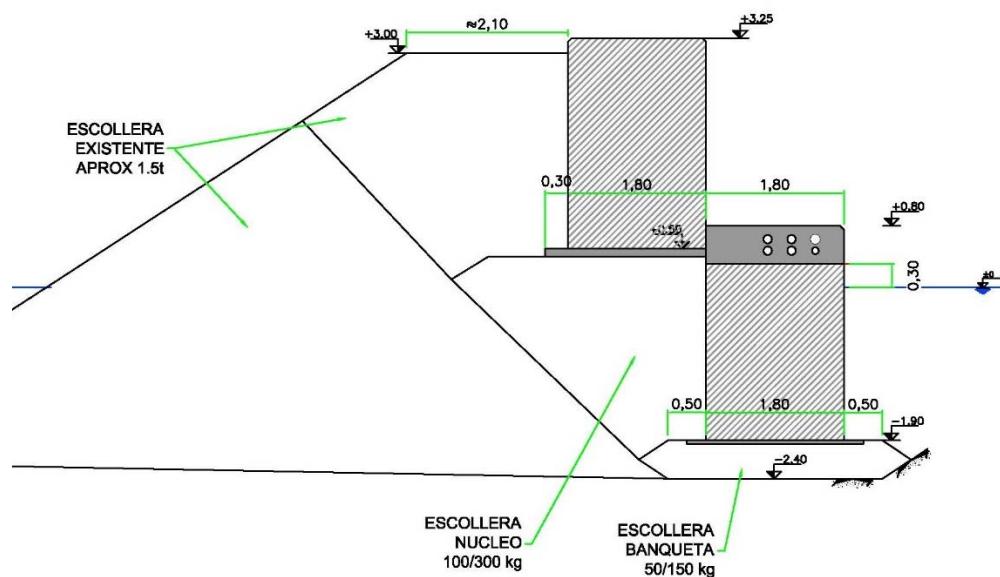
Sección del Dique y muelle de Poniente propuesta en el Proyecto Modificado N°1
